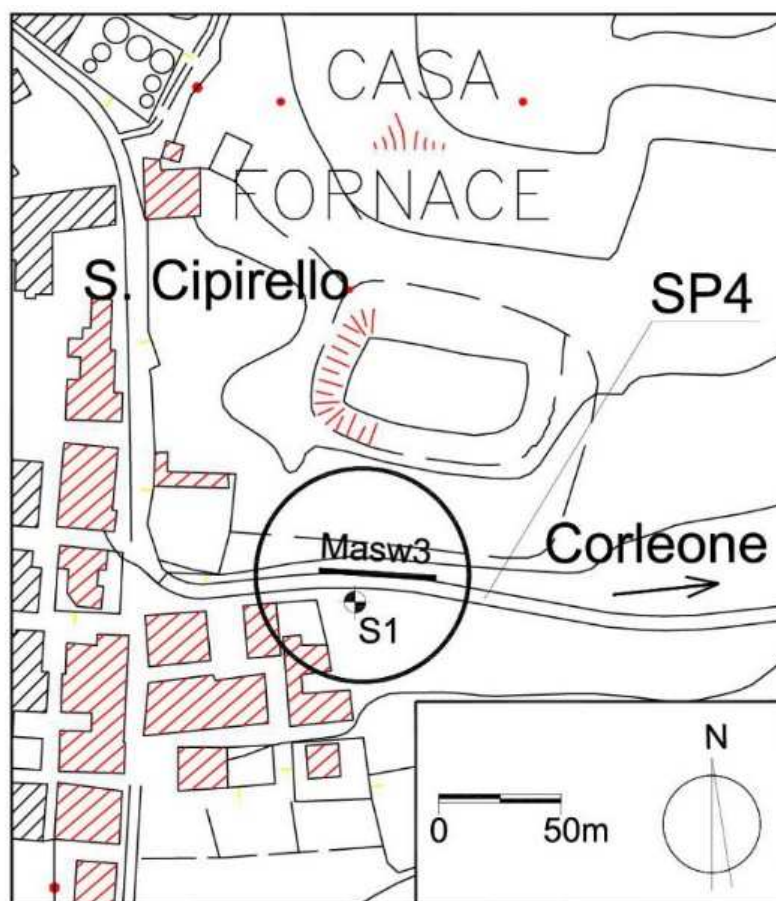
Strada provinciale n. 4. S.Cipirello-Corleone. Planimetria con indicazione della zona oggetto di interesse al km 0+500 e delle indagini eseguite. Il sondaggio S1 è stato attrezzato con piezometro a tubo aperto.
